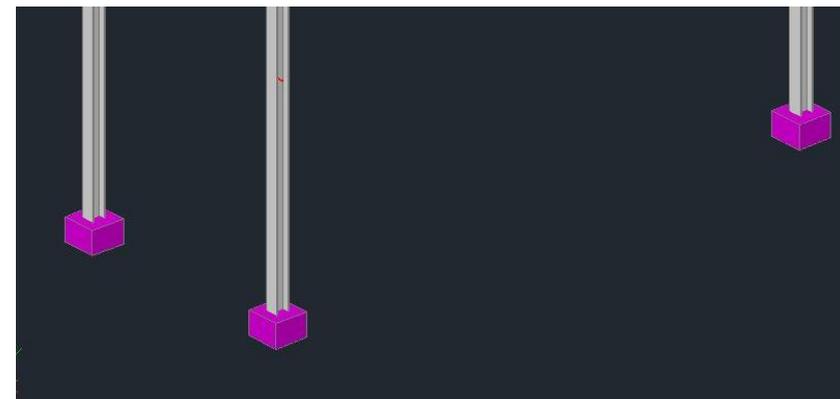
5 Modelado apoyos empotrados y orientación perfiles HEB
